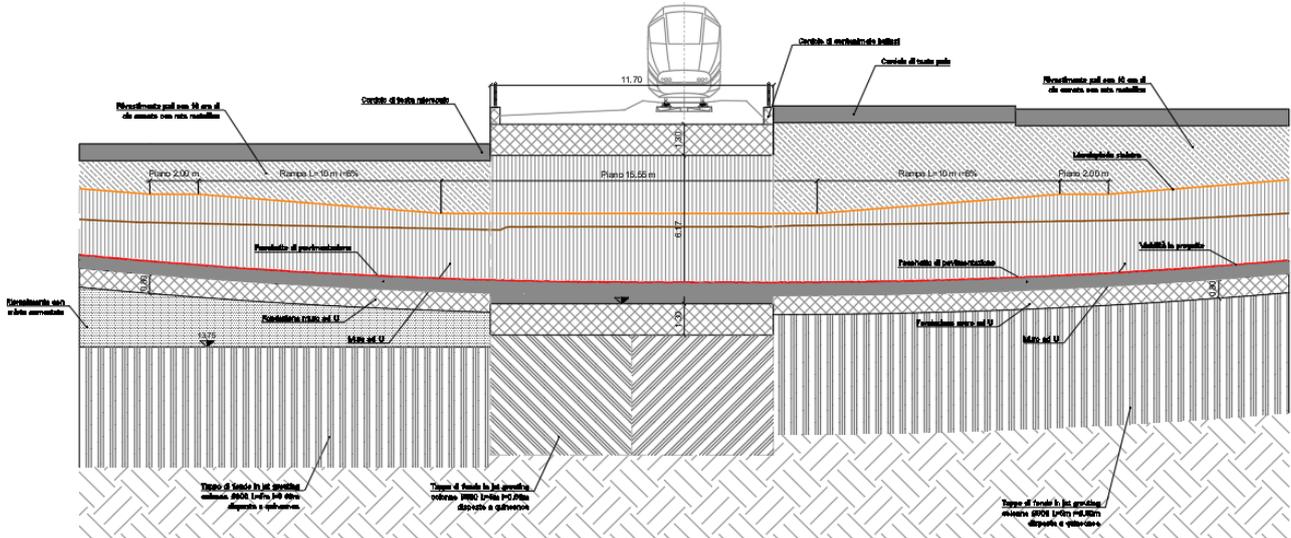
Sottovia ferroviaria – Sezione longitudinale
